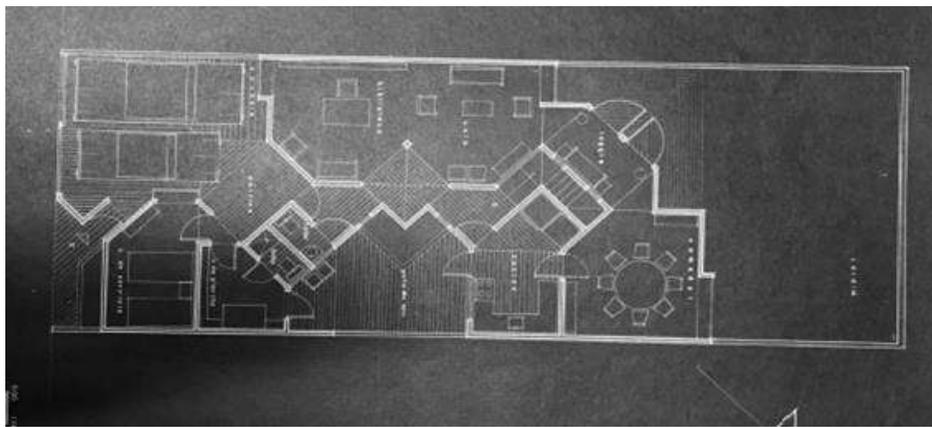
Planta de la vivienda Alhelíes, 1970.
